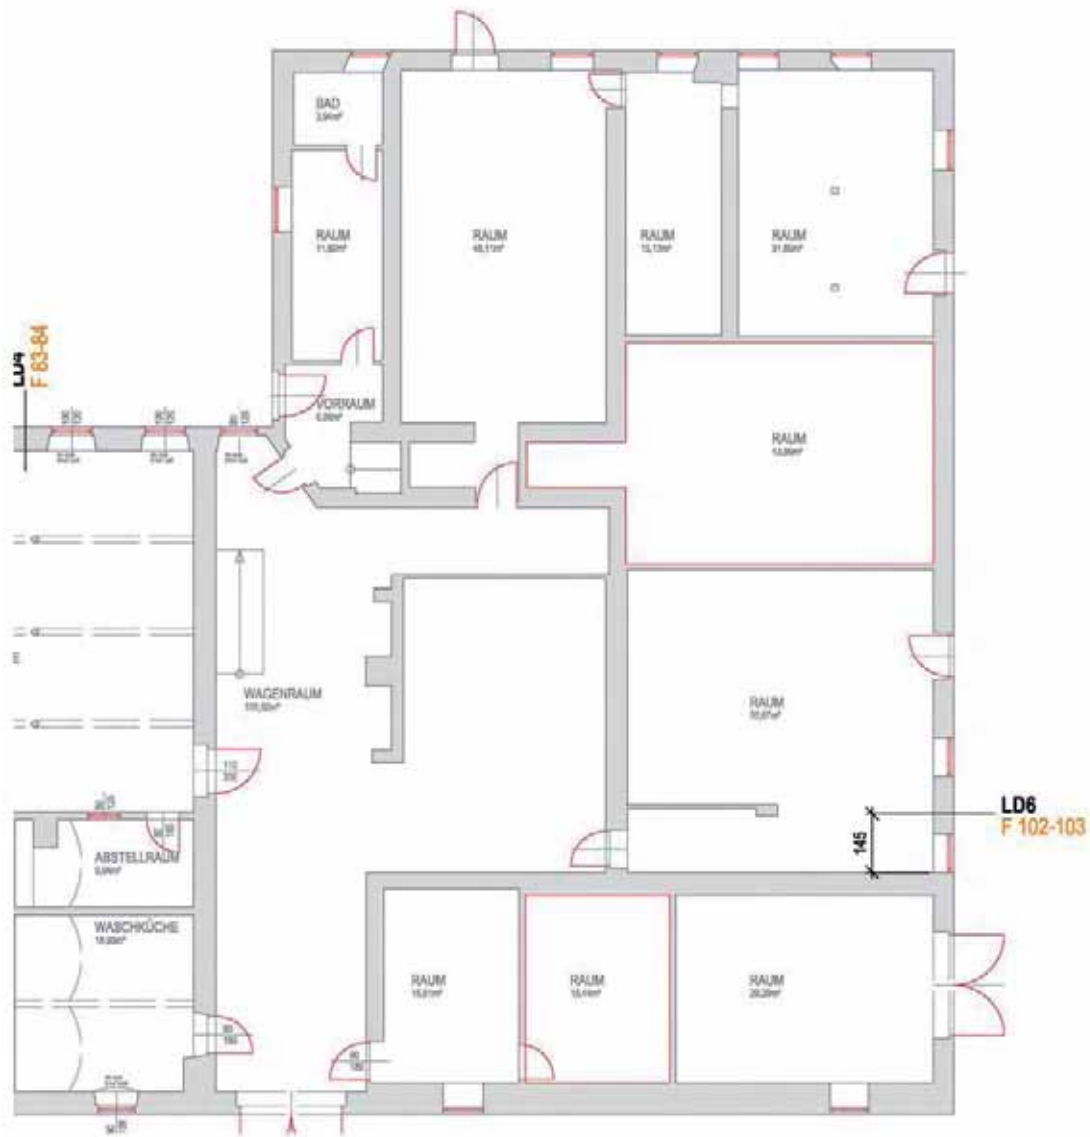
Plan A3 – 3: Position der Achse 6 (LD 6) im Grundriss
